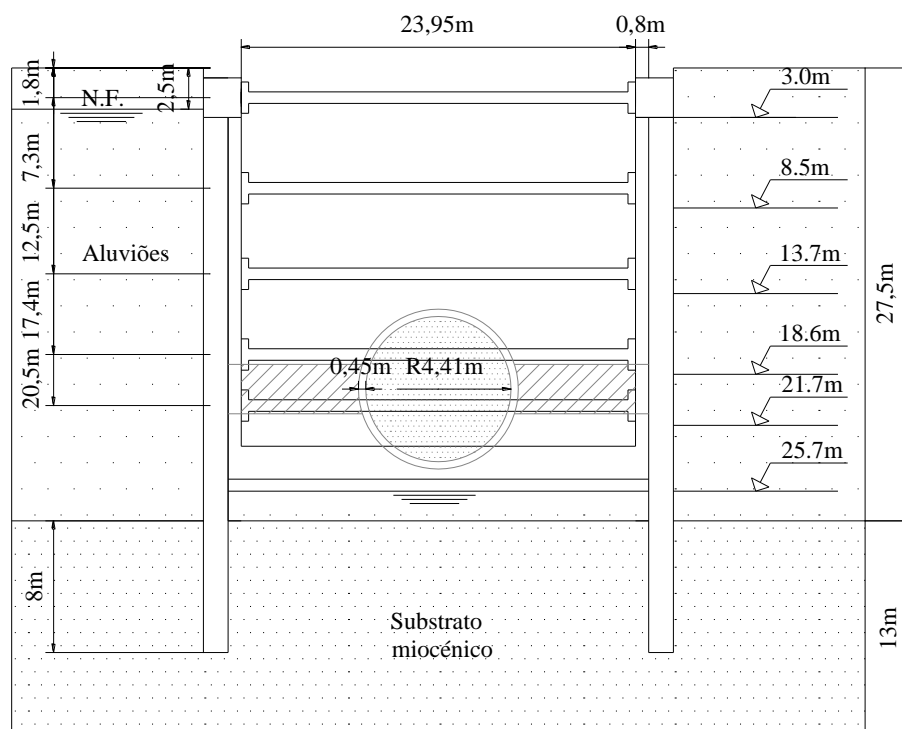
Perfil transversal tipo da escavação na zona larga
